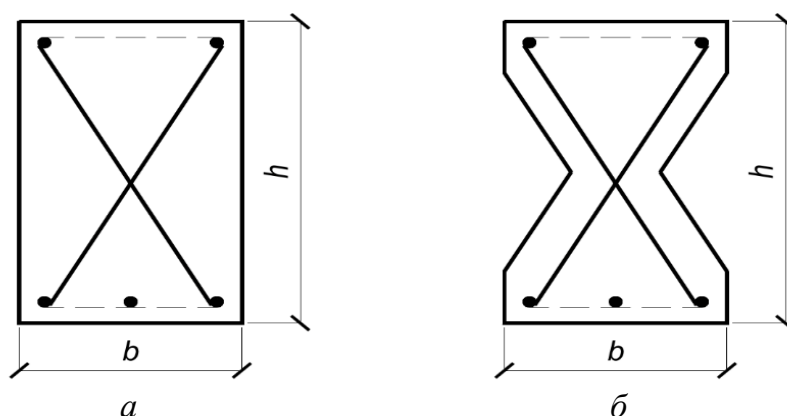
Поперечные сечения железобетонной балки, армированной плоскими диагональными каркасами:
